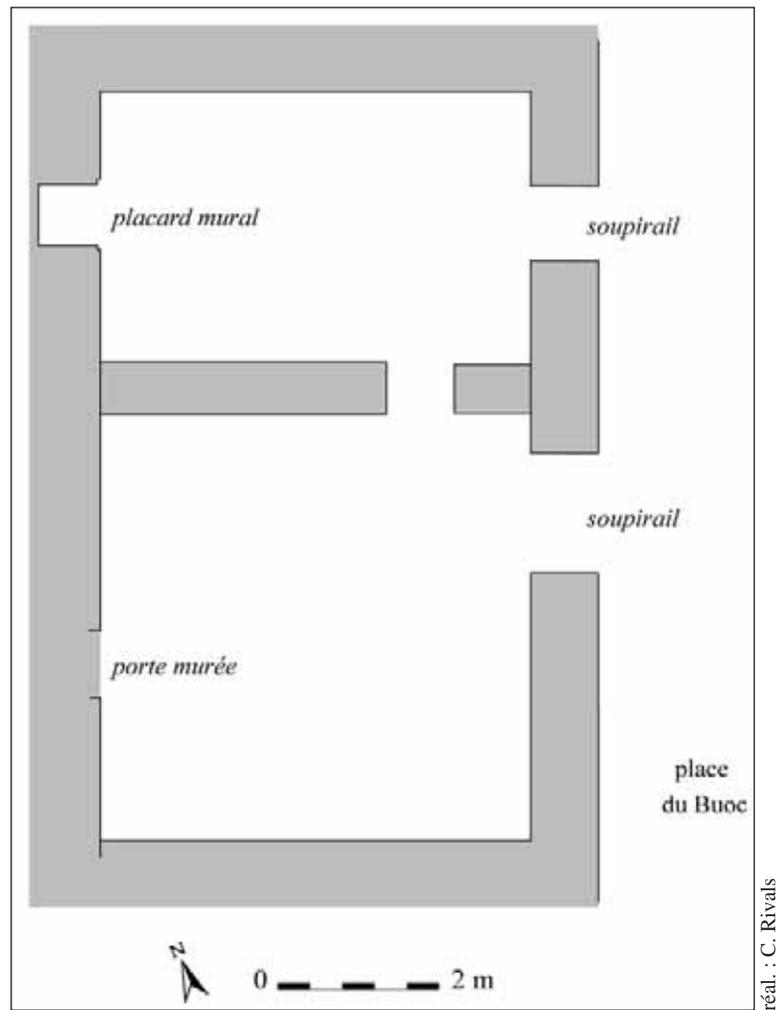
croquis à l'échelle du plan de la cave sous la partie sud de la maison
